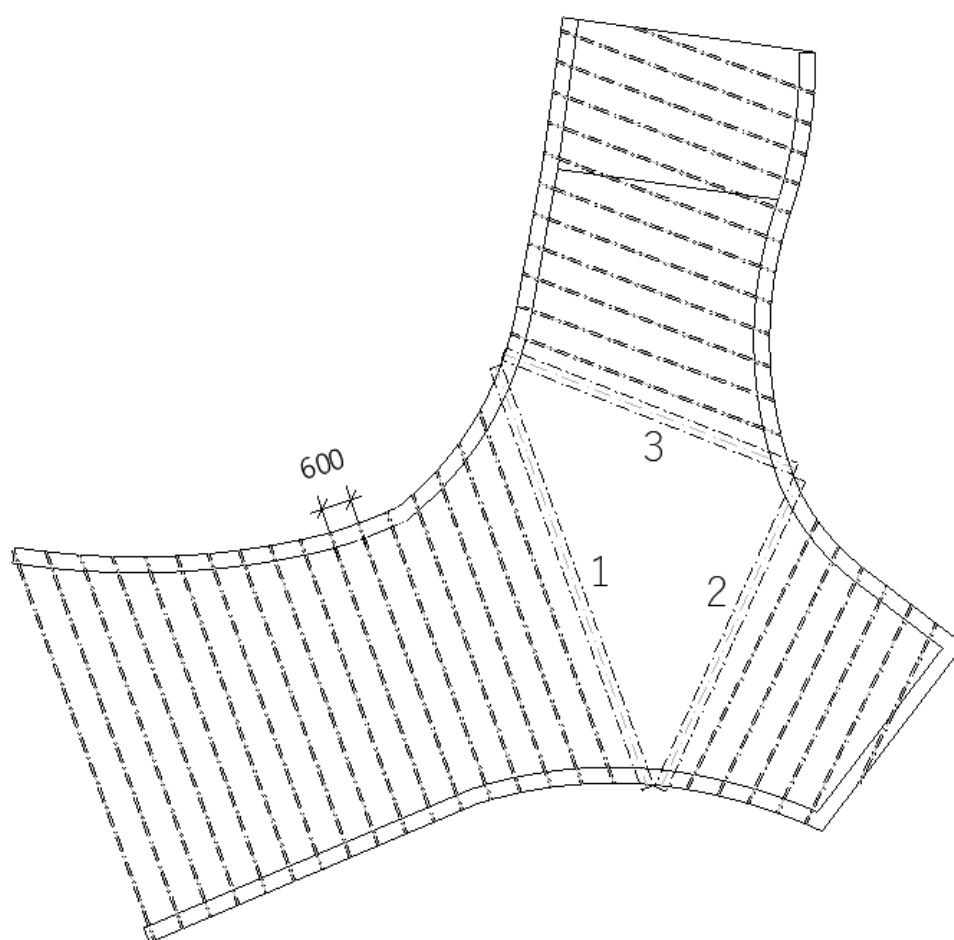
Plassering av stålbjelker og massivtreelementer. Skissert av studentgruppen.
